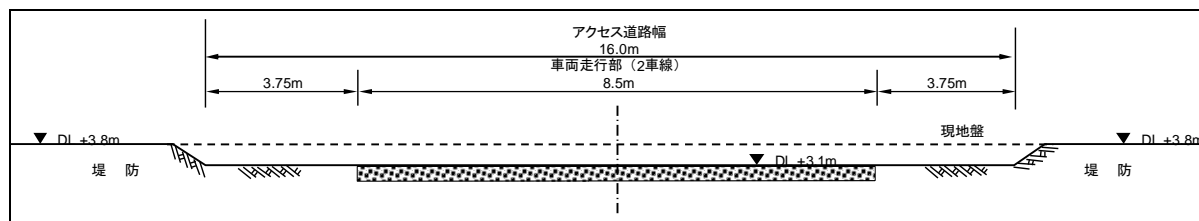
南側アクセス道路の堤防部の横断面図
